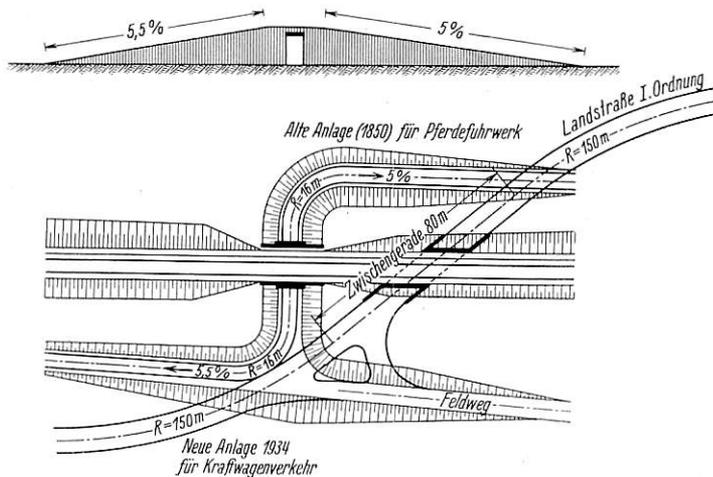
Kreuzungsanlage Hauptbahn und Staatsstraße Stuttgart-Ulm (bestehende Anlage und Umbauplan).
